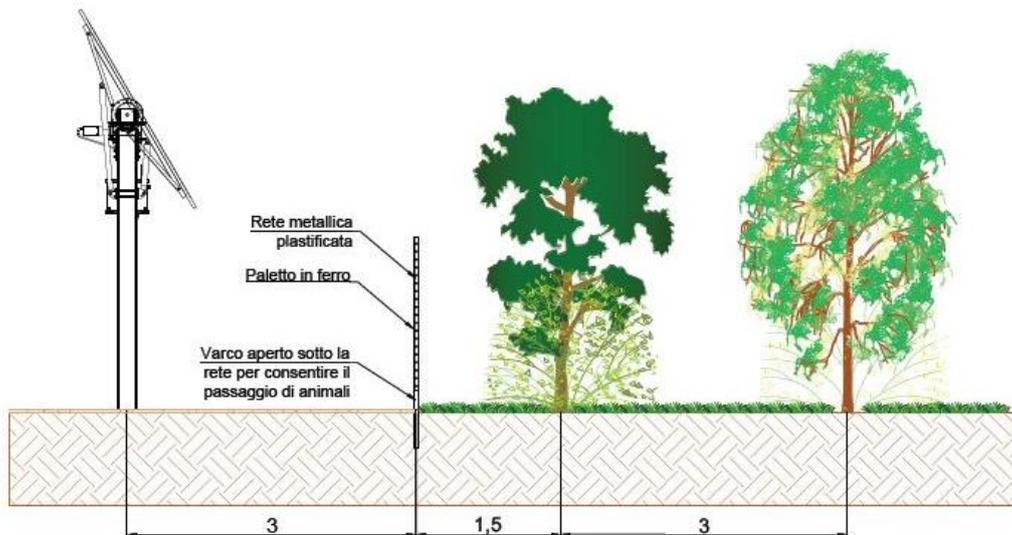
Sezione della porzione inerente la recinzione perimetrale dell'impianto con posizionamento delle piante autoctone.
